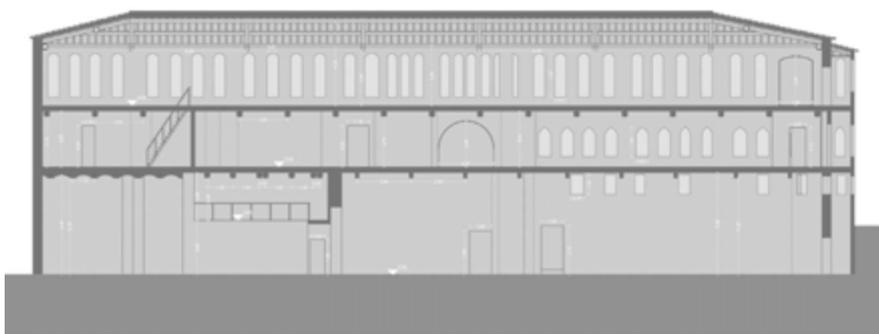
Sezione longitudinale intermedia dello stato di fatto
